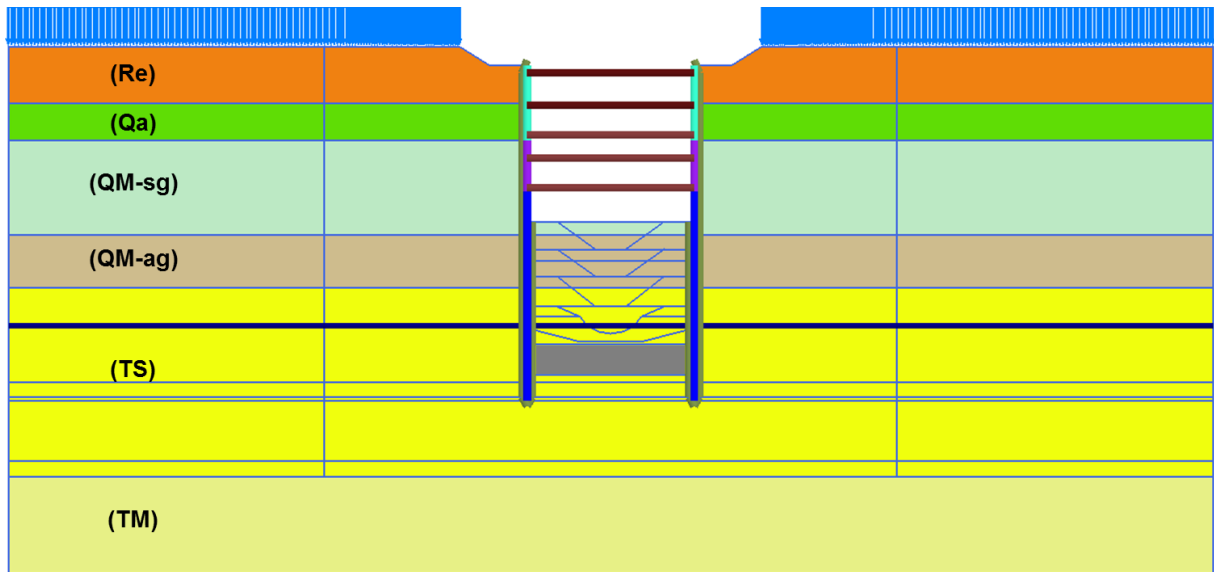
Fase 17: Sétima fase de escavação, à mesma profundidade que a sexta fase, escavando somente as banquetas
